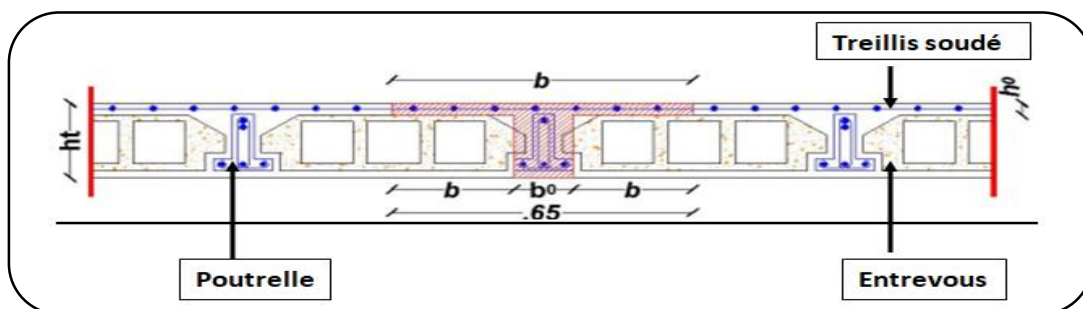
Les éléments principaux d'un plancher à corps creux.
